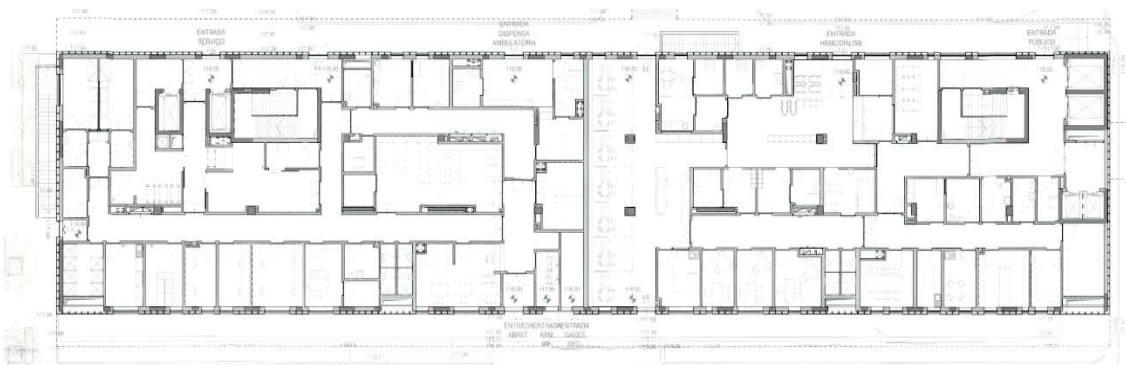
Planta de implantação do futuro edifício do HFAR. Adaptado [43].
